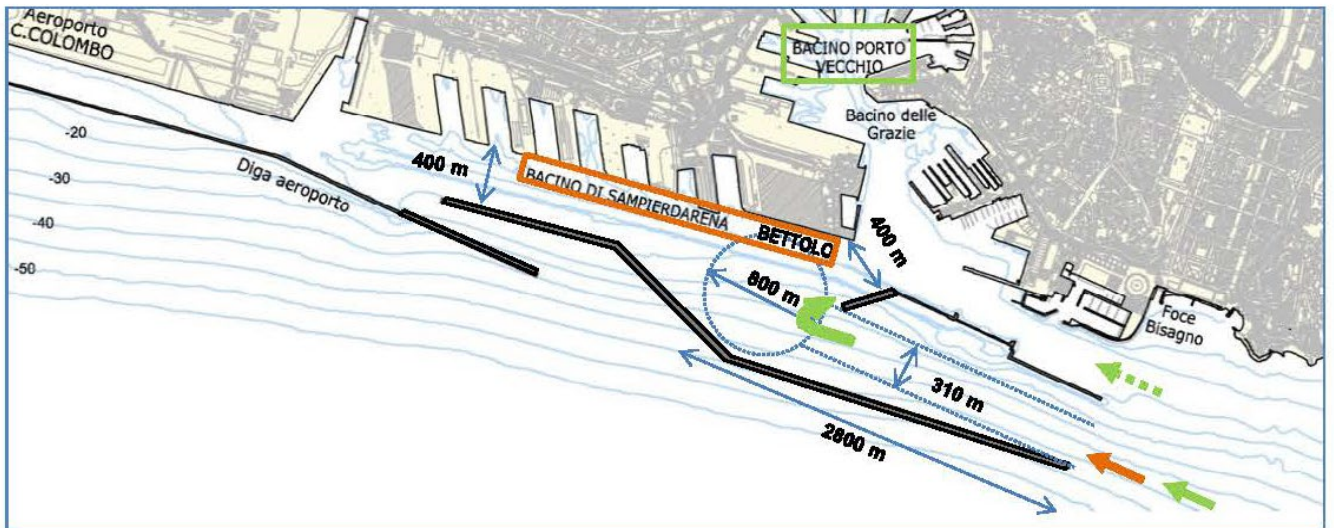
PLANIMETRIA DELLA NUOVA DIGA FORANEA NELLA SUA CONFIGURAZIONE FINALE
